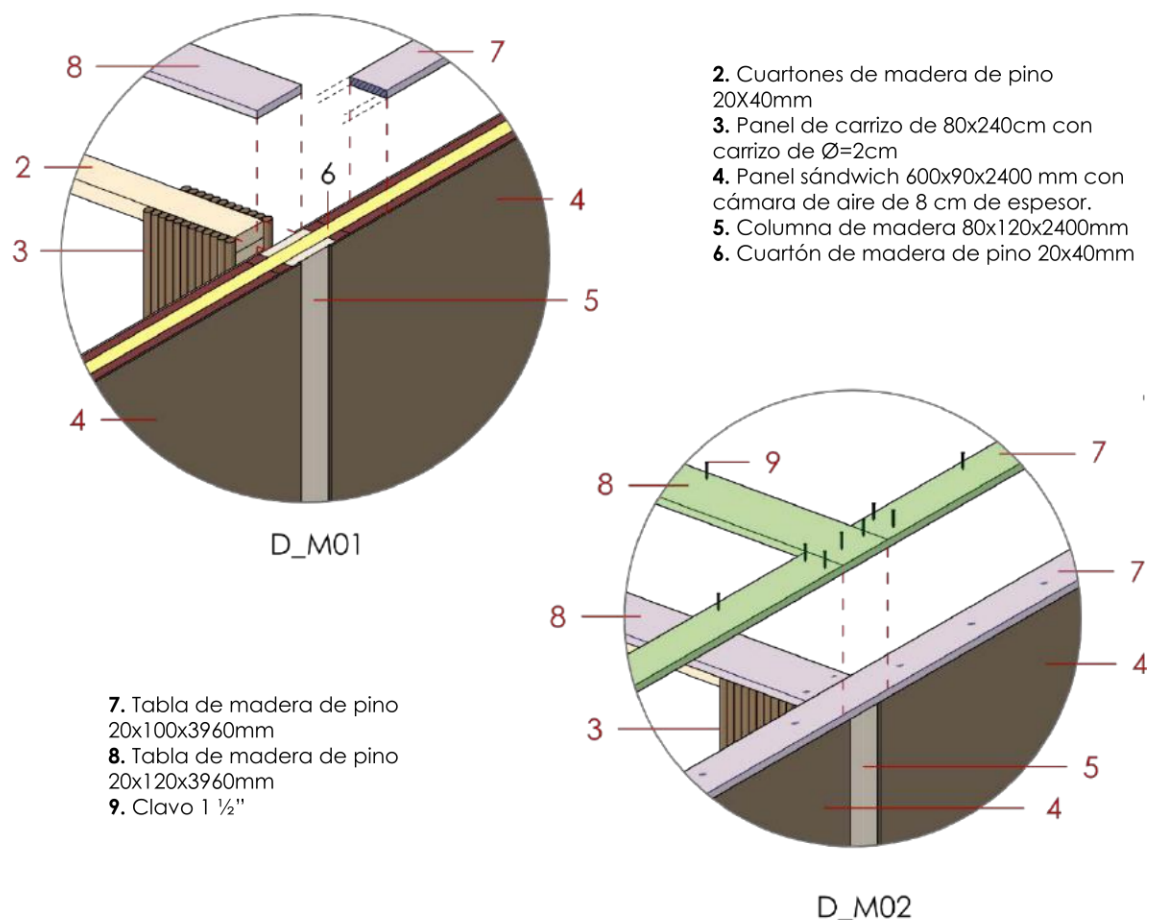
Unión de la mampostería de carrizo con la mampostería exterior.
